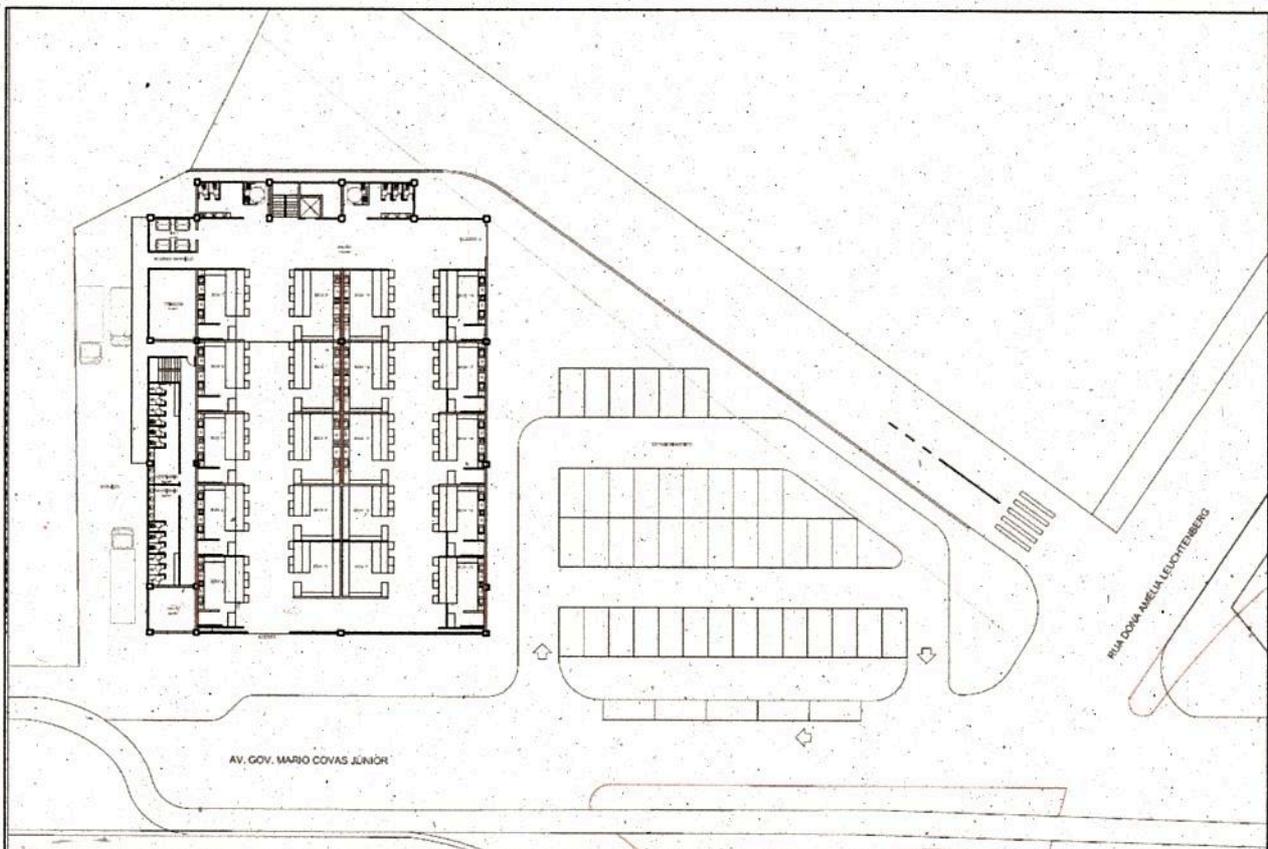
Imagem da planta baixa do pavimento térreo proposto para o equipamento.
